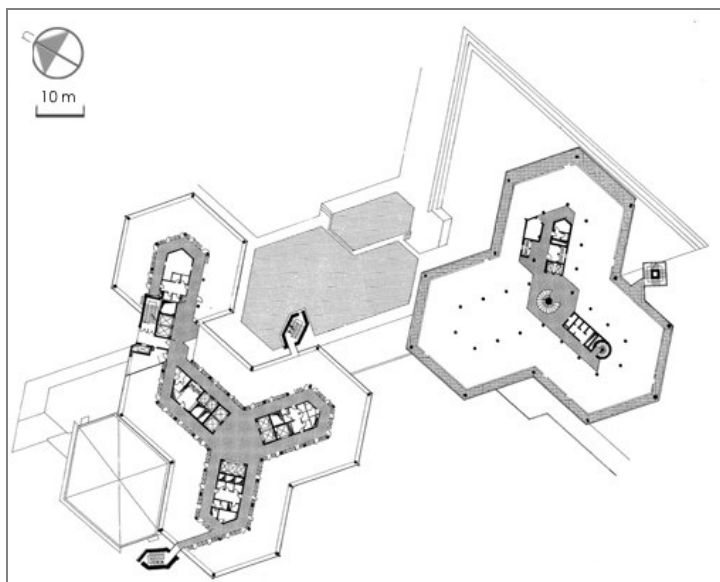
Il palazzo uffici, architetti nizzoli e oliveri, 1955-1957. pianta piano tipo
